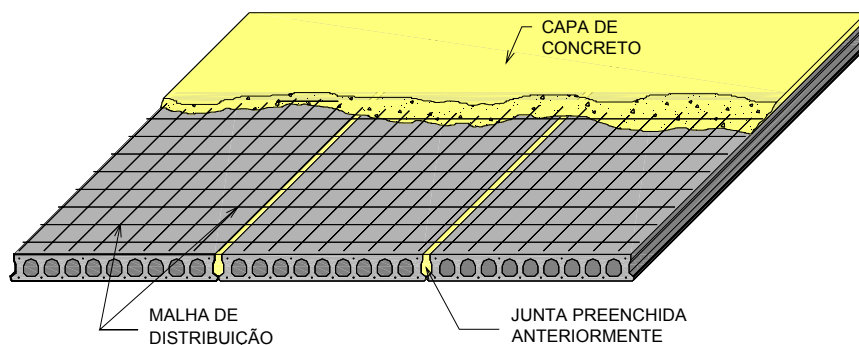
Capa de concreto executada sobre os painéis alveolares
